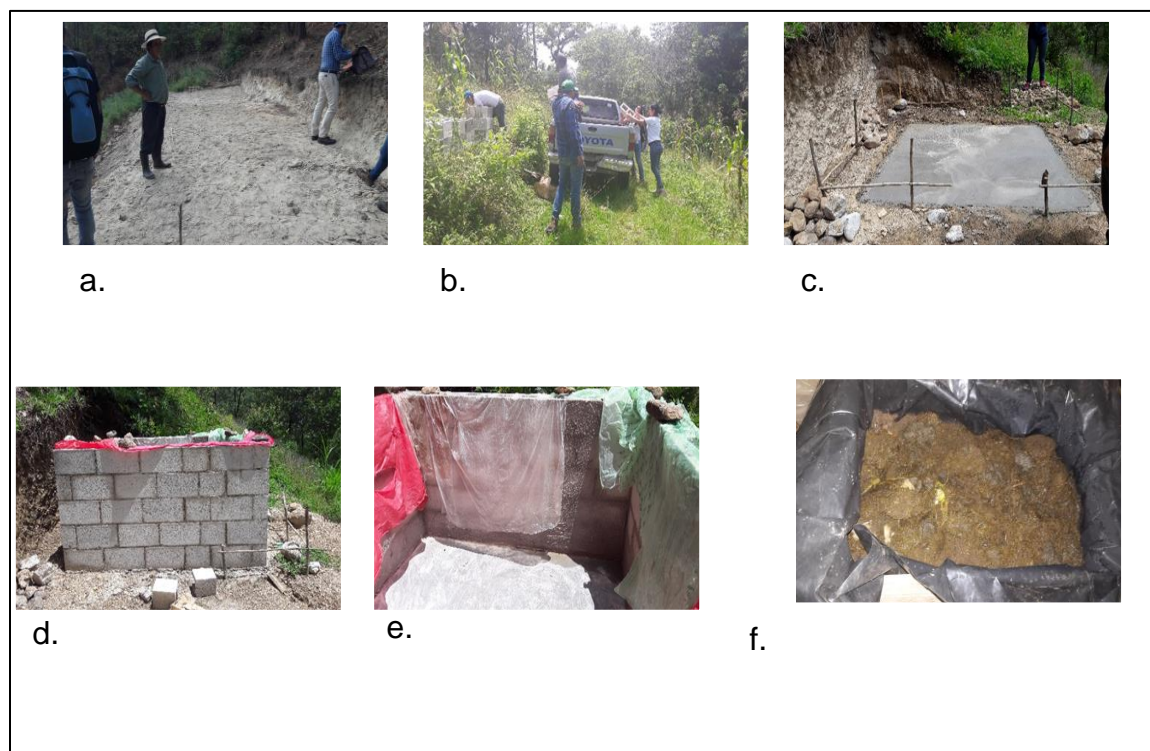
Proceso de construcción de las piletas e implementación de lombricomposteras. a) Preparación del área de construcción, b) Transporte de materiales, c) Inicio de construcción, d) Pileta en fase de secado, e) Pileta terminada, f) Implementación de lombricompostera.
